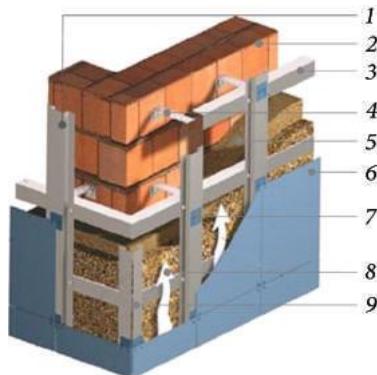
Монтаж фасадных панелей: 1 — профиль вертикальный; 2 — несущая стена; 3 — профиль горизонтальный; 4 — кронштейн; 5 — утеплитель; 6 — облицовочные плиты из керамогранита; 7 — кляммер; 8 — поток воздуха; 9 — профиль вертикальный промежуточный
